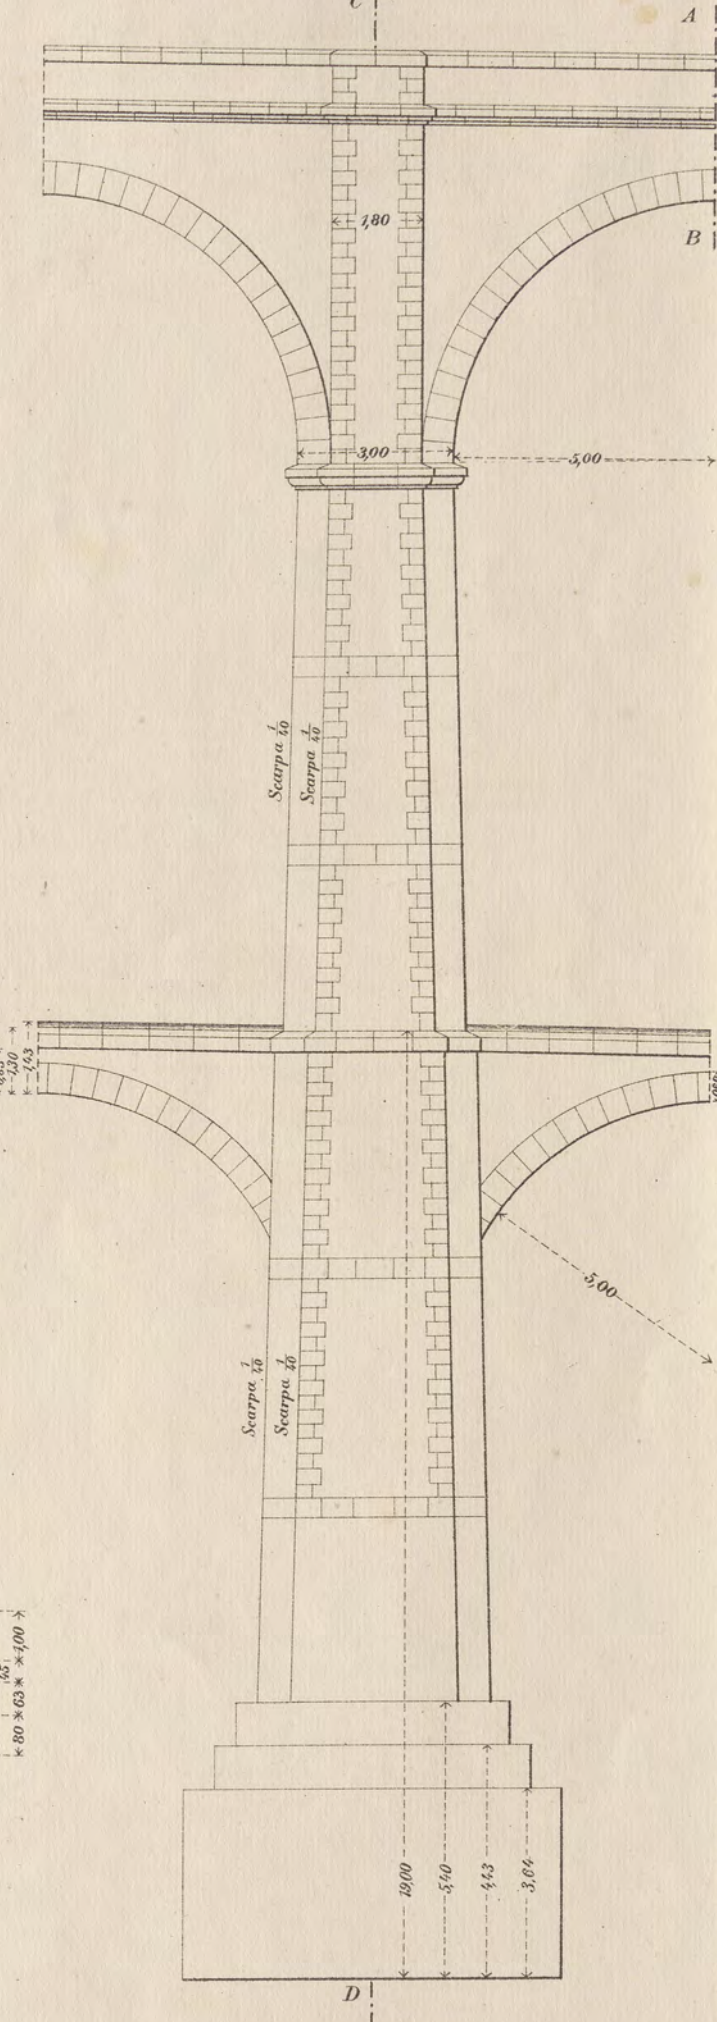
<sup>a</sup> Elevazione di una pila - spalla.
